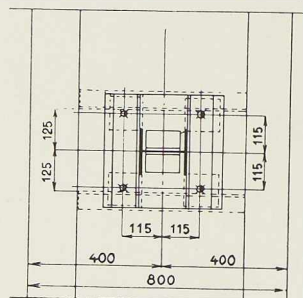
(à droite). Détails de construction d'un pied de colonne.
